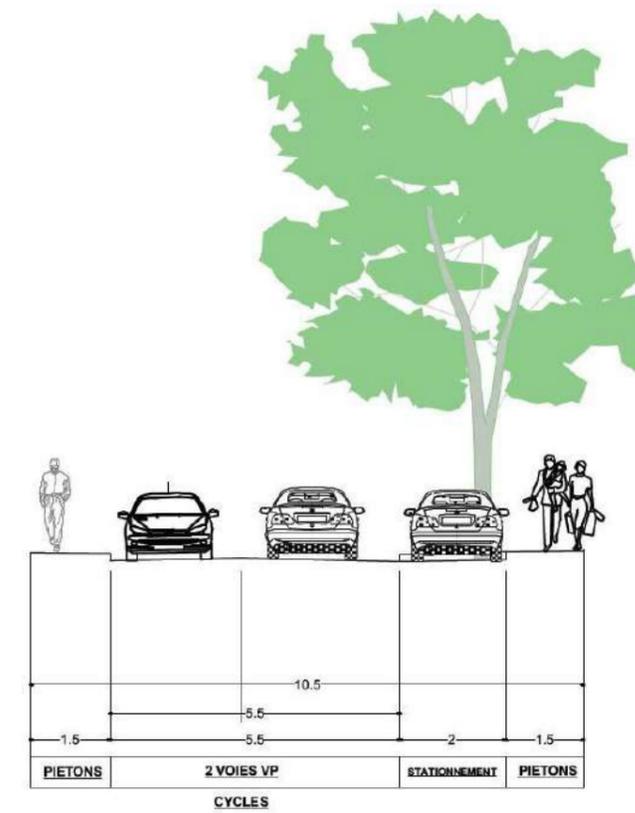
Profil en travers type d'une voie pavillonnaire bi directionnelle
